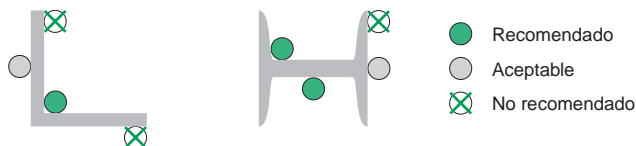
Recomendación para instalar cables en vigas de acero.
